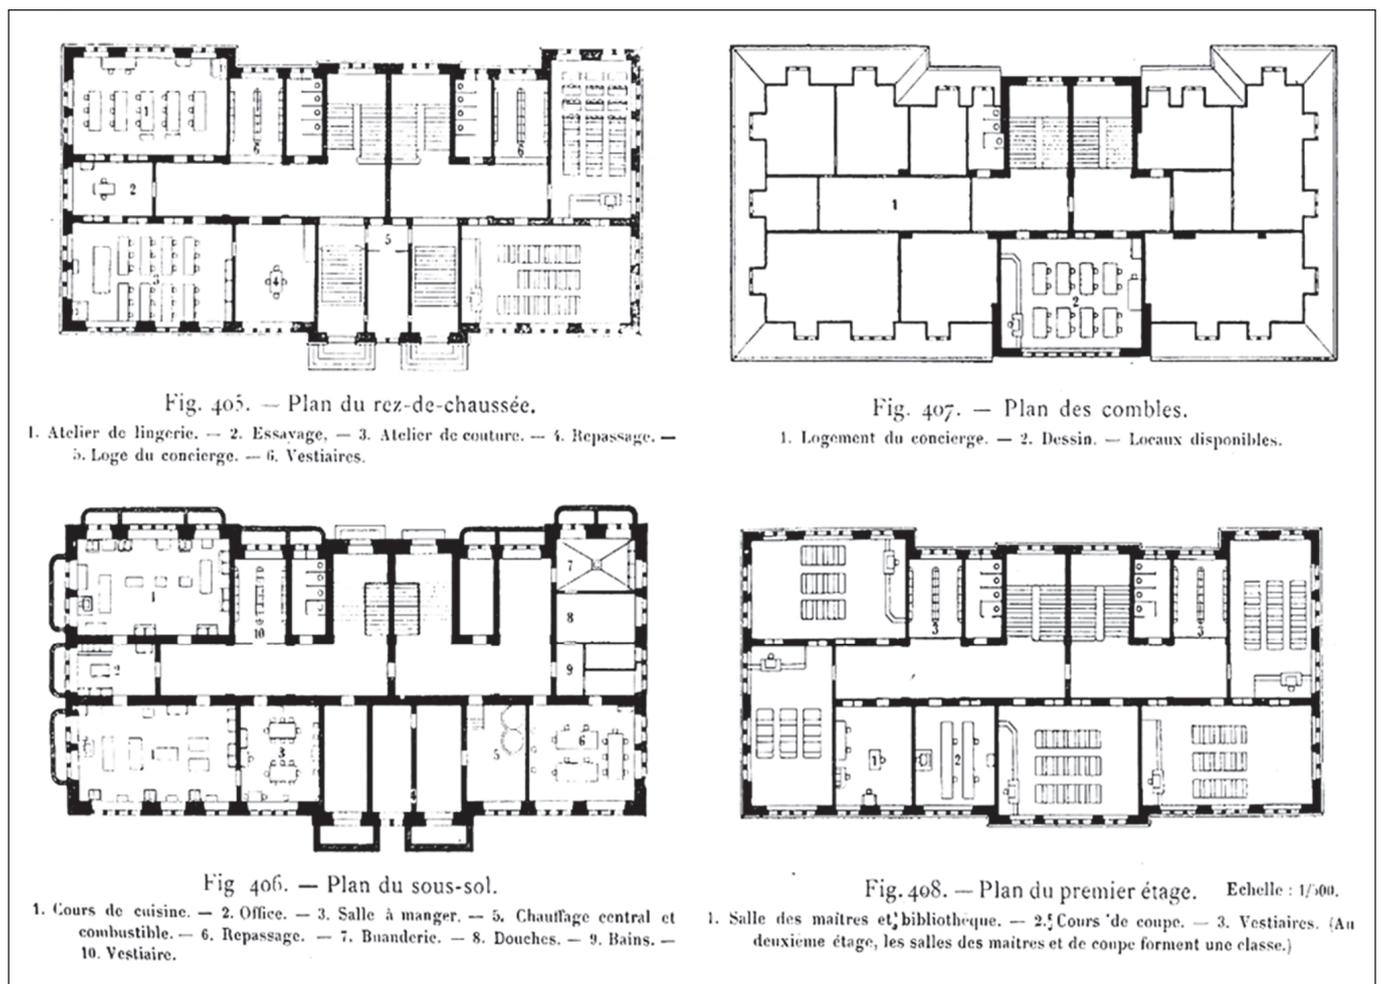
Plans du bâtiment réalisé, publiés en 1907 par Henry Baudin dans son ouvrage sur les constructions scolaires suisses
